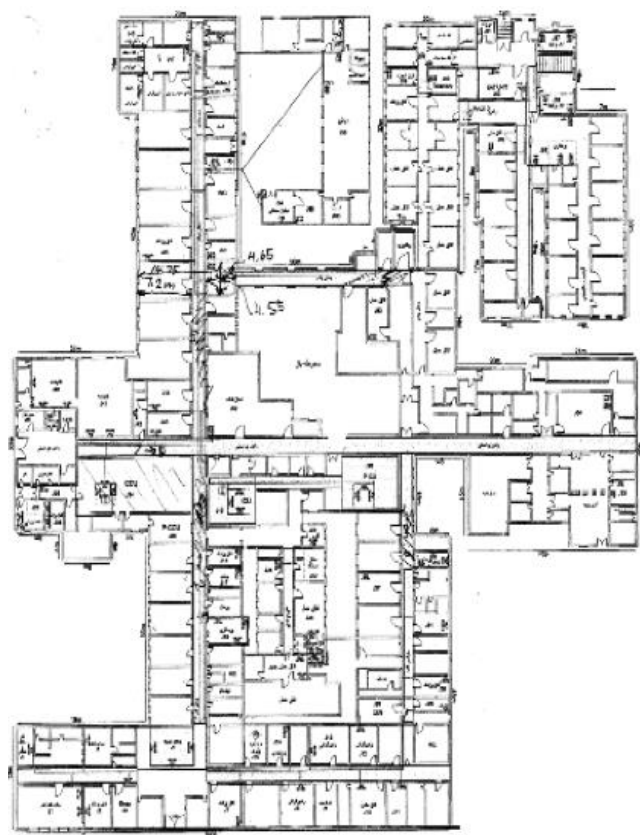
Grundriss des Hauptbaus des Shafa-Spitals in Kerman. Der gesamte Komplex besteht aus einer Anhäufung aneinandergestossener Bauten unterschiedlicher Baujahre und Raumhöhen.
